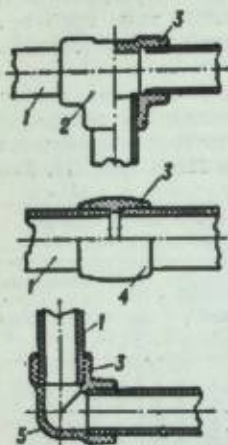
Неразъемные сварные (клеевые) соединения для пластмассовых труб: 1 — труба; 2 — тройник; 3 — плоскость сварки (склеивания); 4 — муфта; 5 — угольник.
